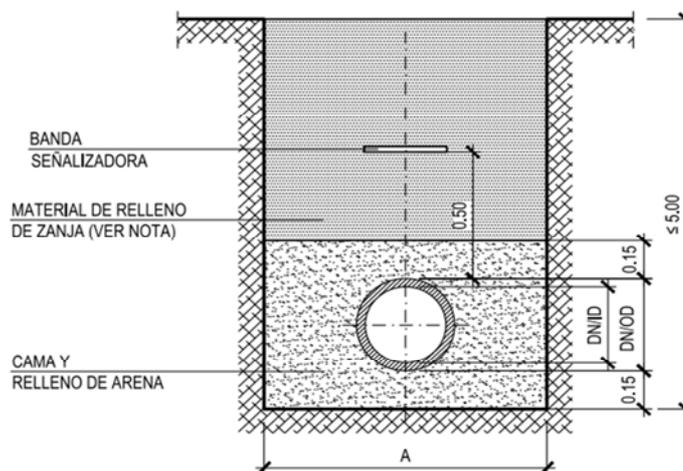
Sección transversal del proyecto para los colectores de conexión de zonas desconectadas
